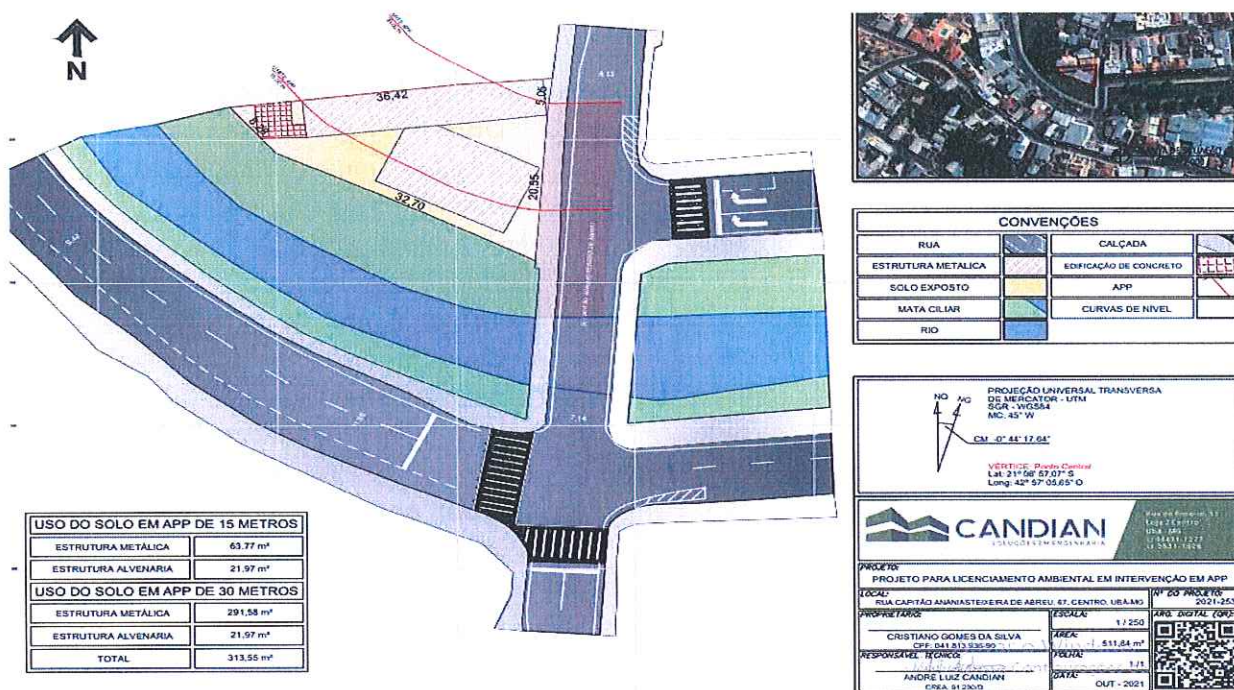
Planta topográfica apresentada com as edificações de estrutura metálica e estrutura de alvenaria, contidas dentro da faixa não edificante da APP.
